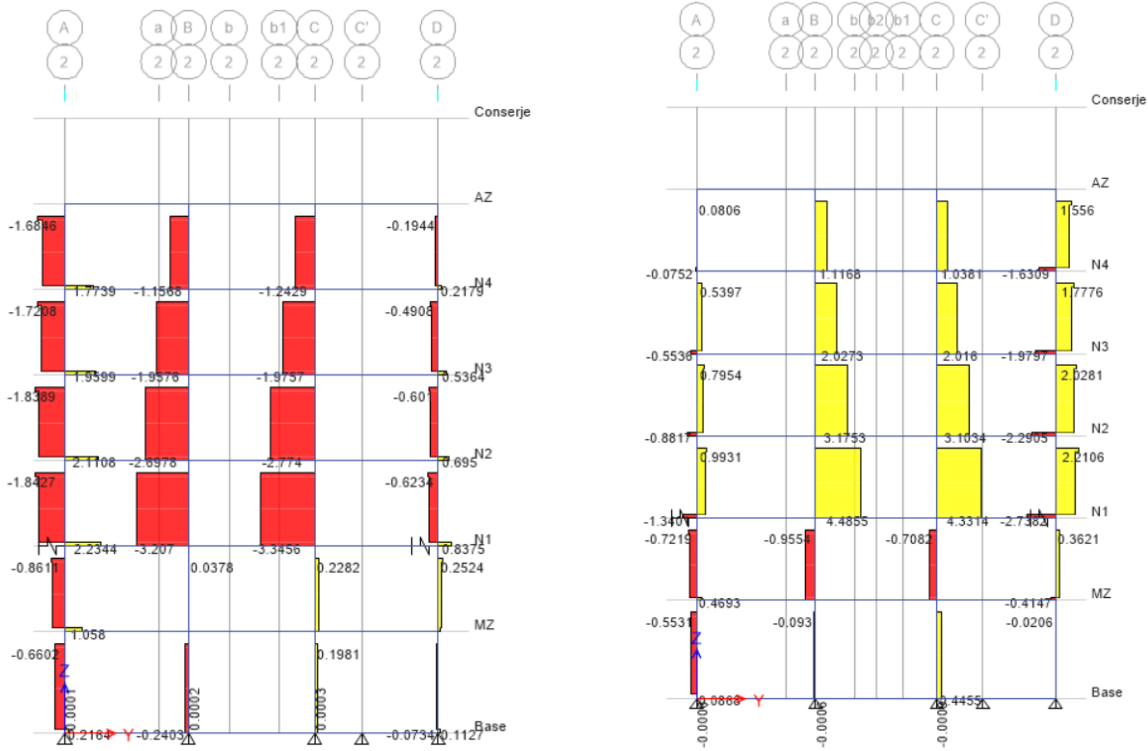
Esfuerzos de corte en columnas elevación 2. Modelos F y G respectivamente.
